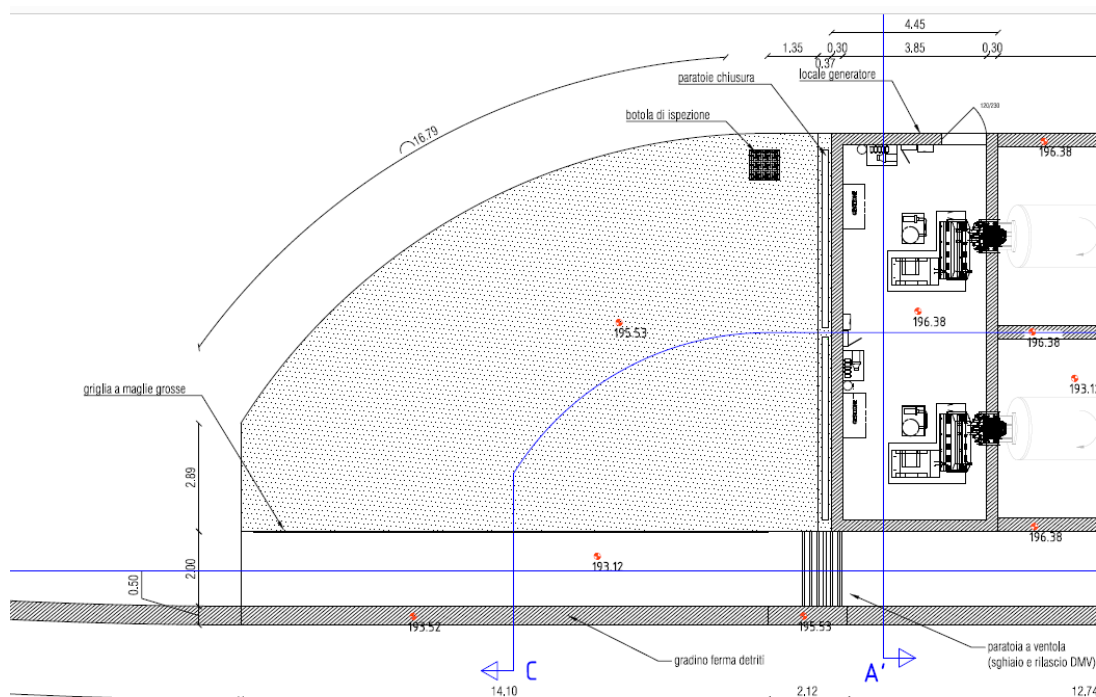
Estratto planimetrico opera di presa e canale di derivazione.
